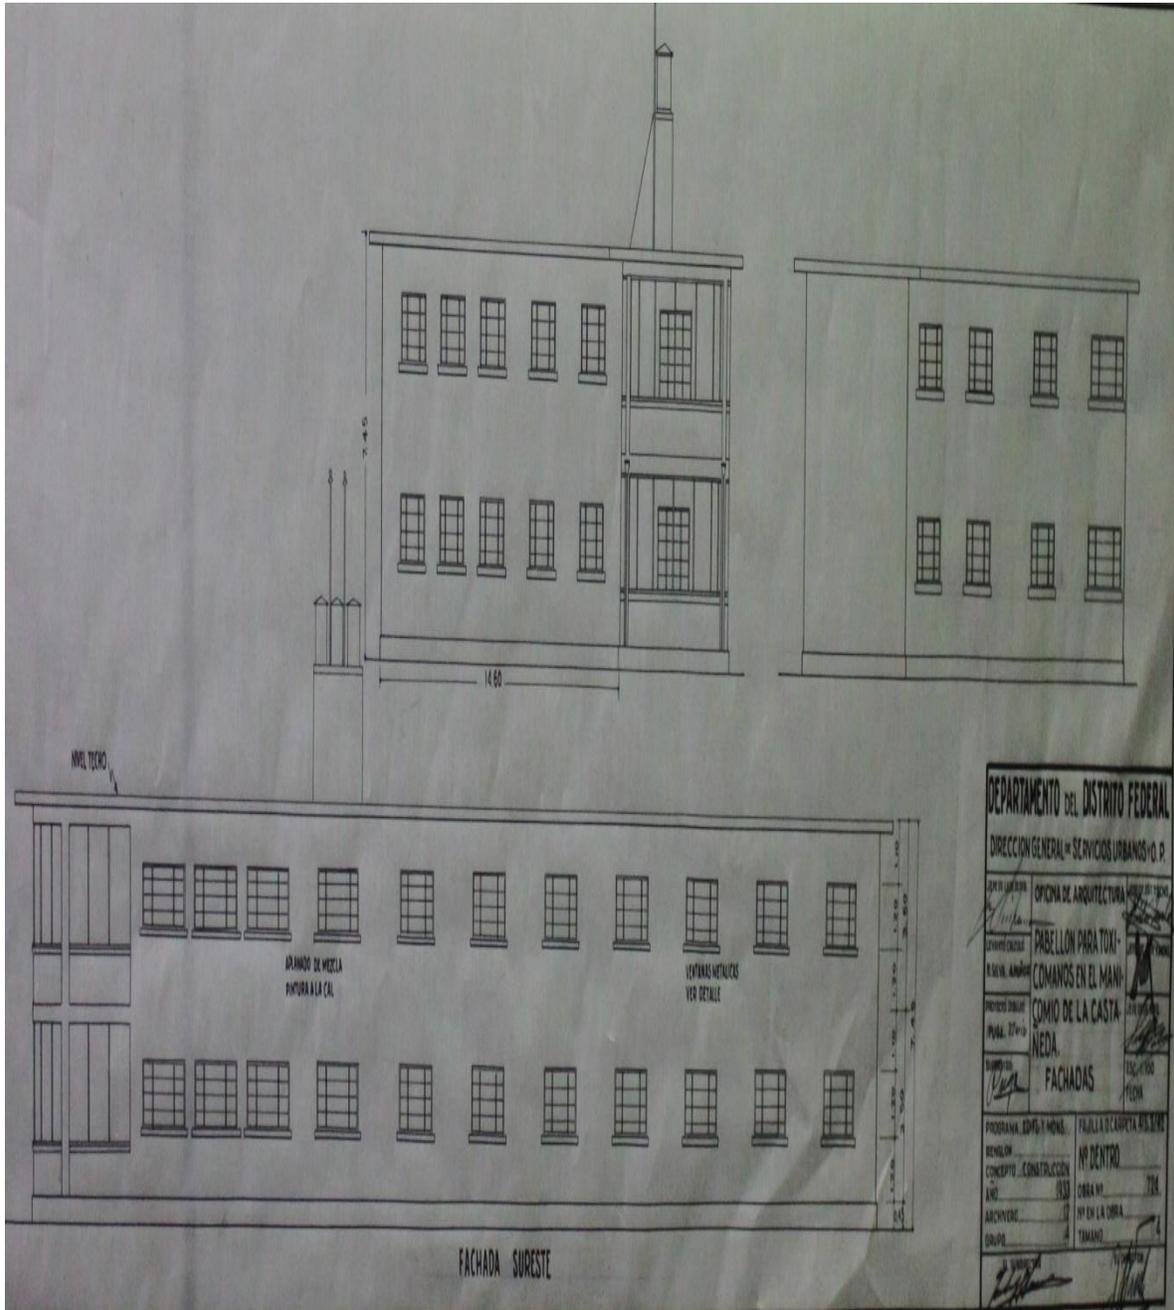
, Fachada del Pabellón de Toxicómanos vista desde afuera, Fuente: AHDF
